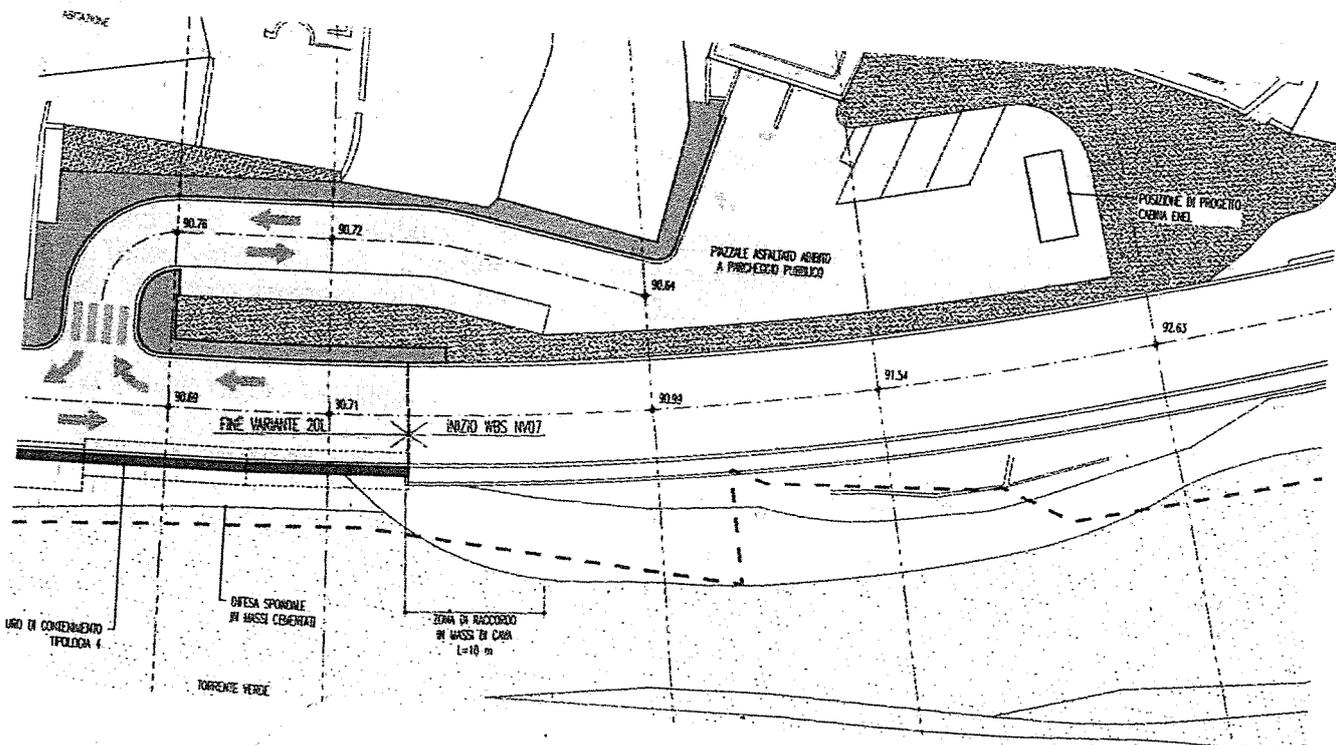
planimetria tratto 5 – piazzetta tratto terminale
